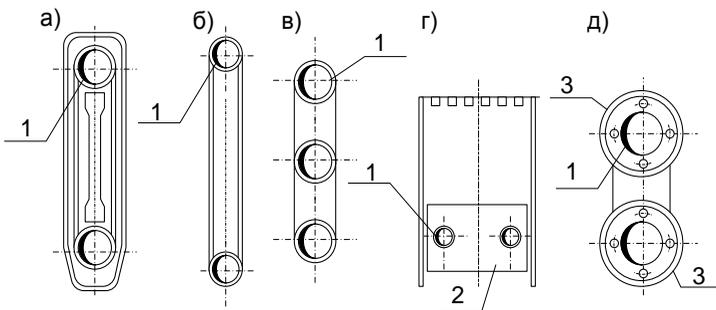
Схемы отопительных приборов различных видов (поперечный разрез):
